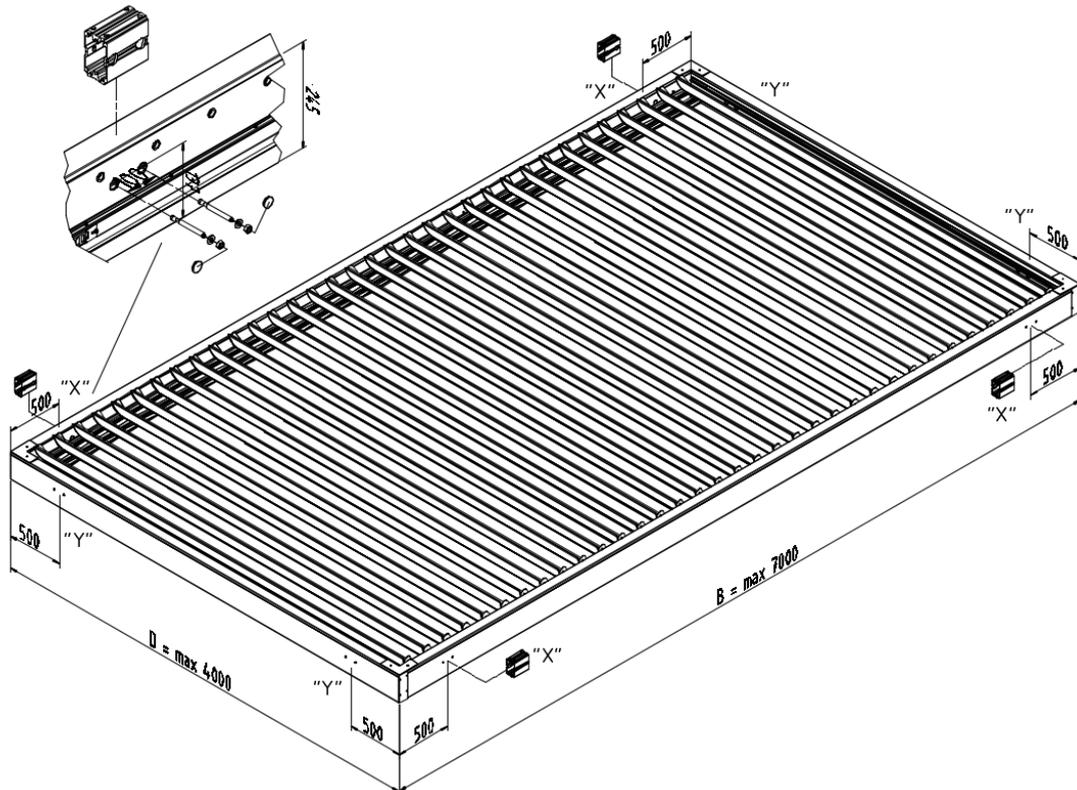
Points d'ancrage recommandés (« X » - de préférence sur les poutres longitudinales - alternativement « Y » sur les poutres transversales)
